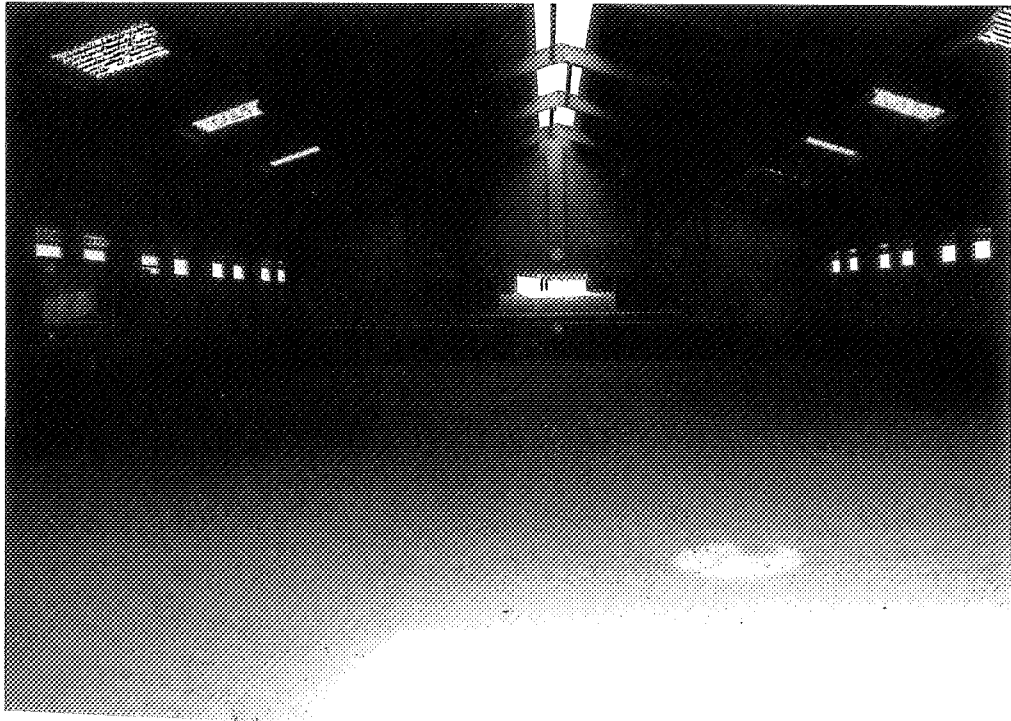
Binnenbak achter boerderij met boringen 21, 28 en 20.
